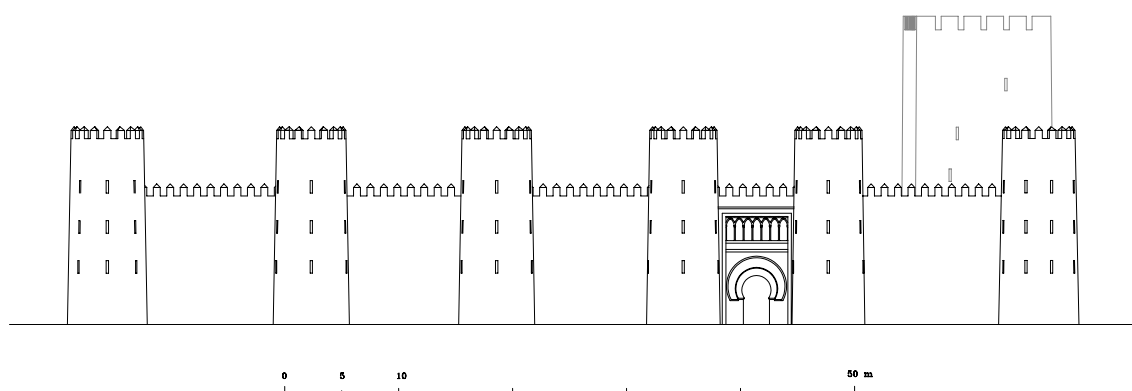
Alzado hipotético del recinto fortificado en el siglo XI
